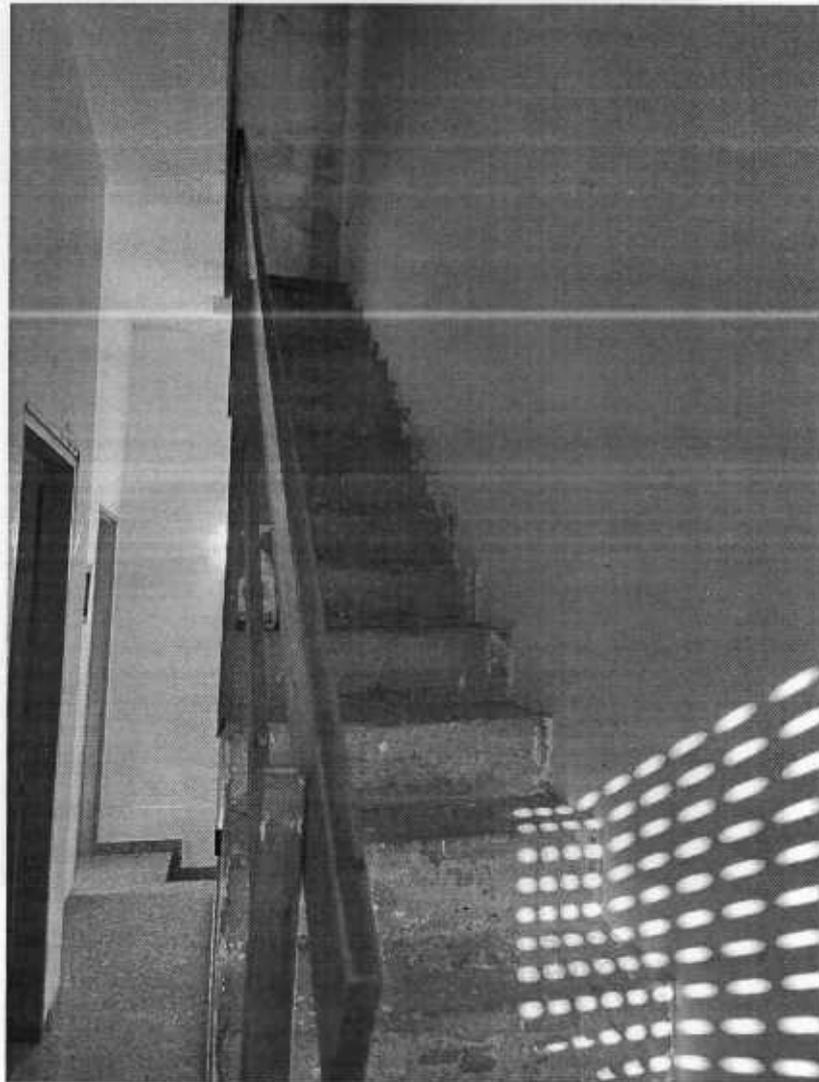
vano scala che collega il piano primo con il piano secondo
